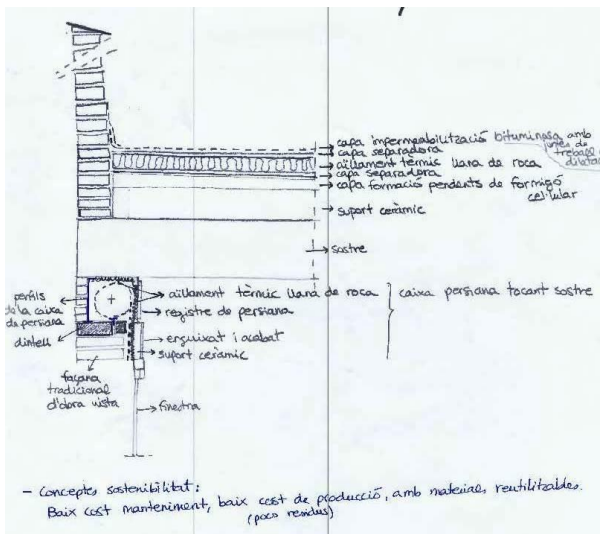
y Fig 6. Detalle: "Sección de cubierta plana en edificio con fachada de obra vista" Bloque 3 Proyectos Técnicos II. 2012. EPSEB
